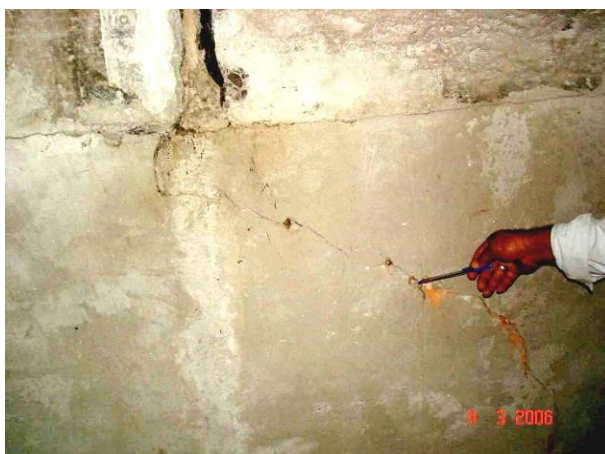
Fissura à 45° encontrada na Casa de Força da UHE Passo Fundo.
